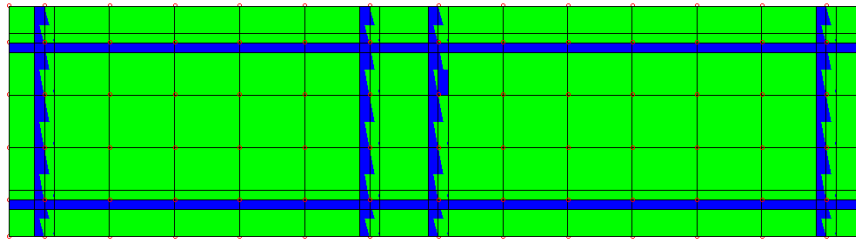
Vista in Pianta Platea e Travi di Fondazione
